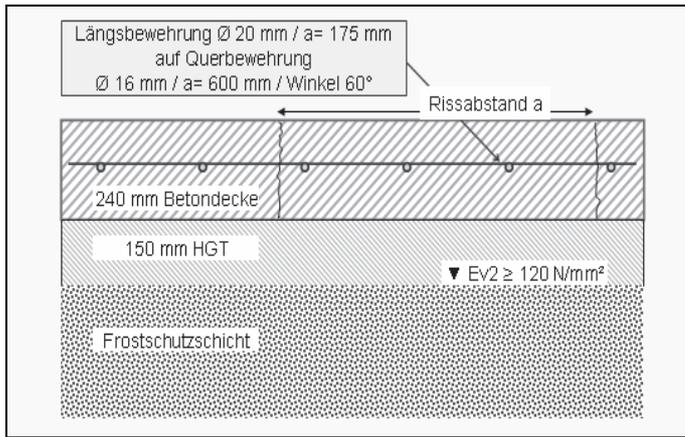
Aufbau einer durchgehend bewehrten Betondecke für die Bauklasse SV im Längsschnitt, Bewehrungsgrad der Längsbewehrung = 0,75 %
